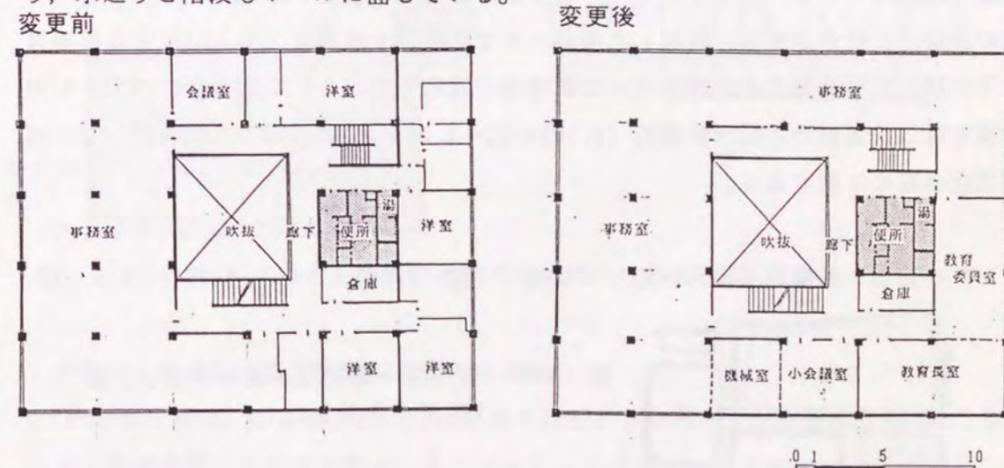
<25>札幌市教育委員会庁舎(旧交通局庁舎)一般階平面図
